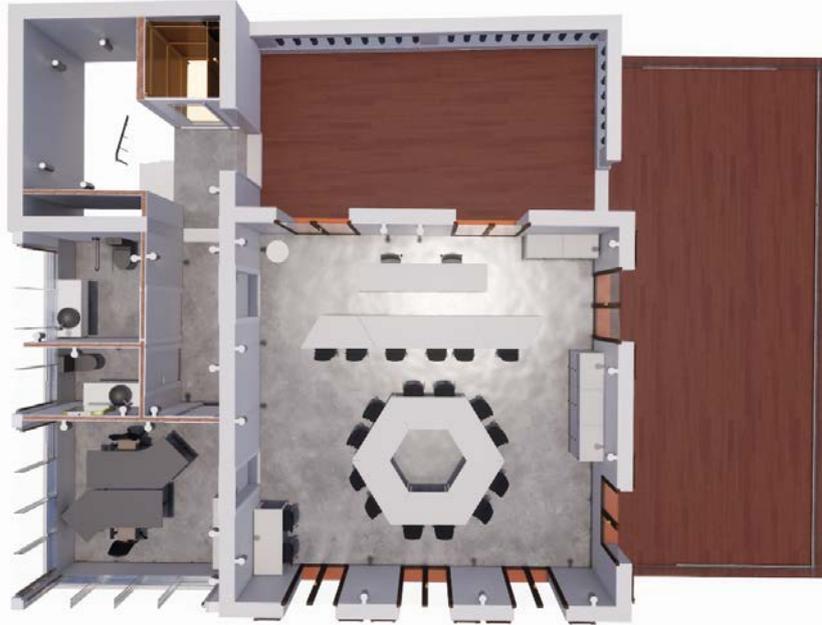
Renderizado, vista cenital edificio cortando por la planta primera.
